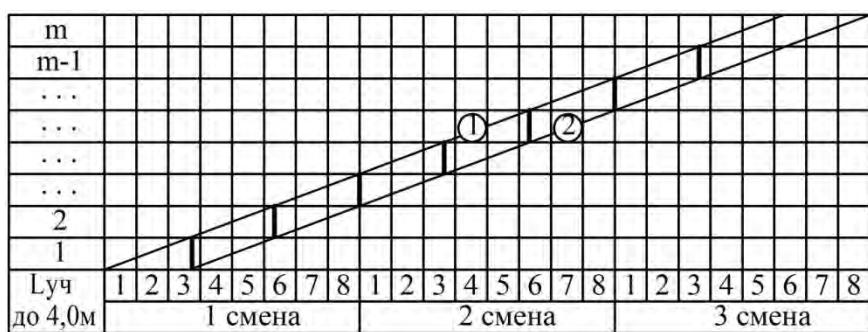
Общий вид циклограммы по возведению монолитных плит: 1 – подготовка основания, армирование плит, установка и разборка опалубки; 2 – укладка и уход за бетоном
